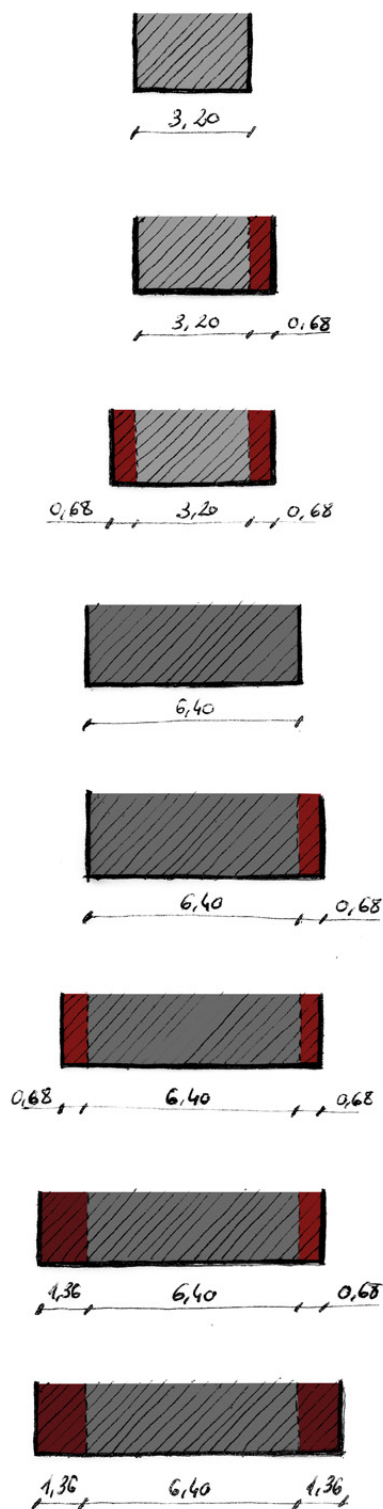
Posibles combinaciones anchos de fachada en la trama actual de El Cabanyal
